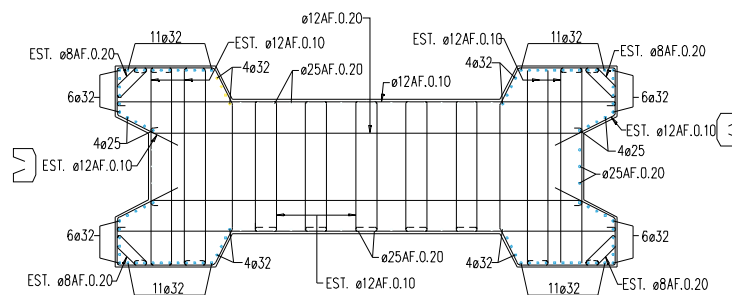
Armadura longitudinal e transversal dos pilares P1 a P5 e P9 a P17 (base).
